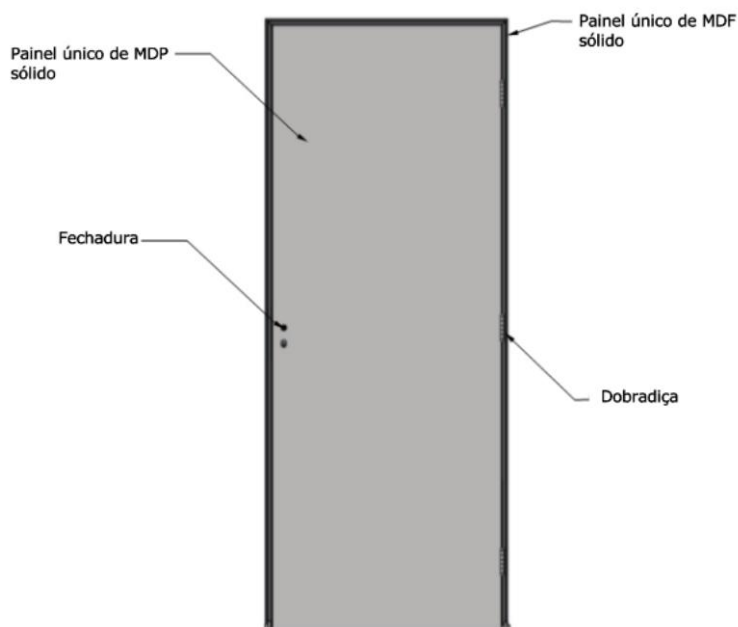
Esquema em vista da porta de painel único, objeto desta Diretriz (sem escala)
